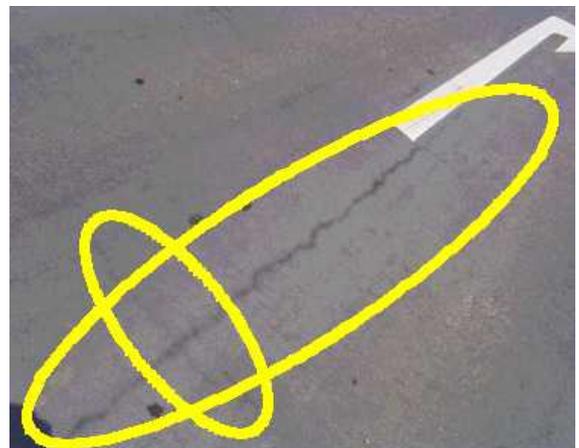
散水養生不足による乾燥収縮ひび割れ
